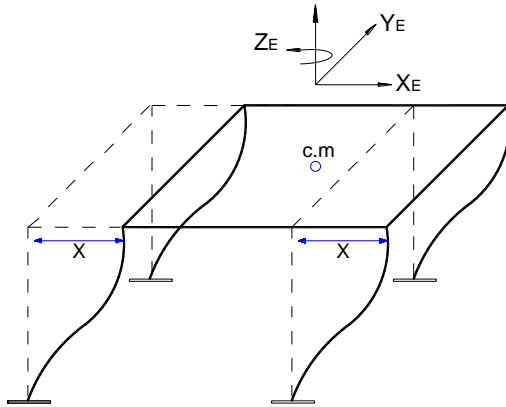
Deformaciones en los elementos de una estructura de un piso, con diafragma rígido en su propio plano, ante un desplazamiento en la dirección X.
